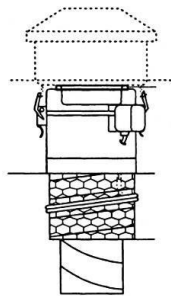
Крышный вентилятор с плоской покрывающей пластиной
